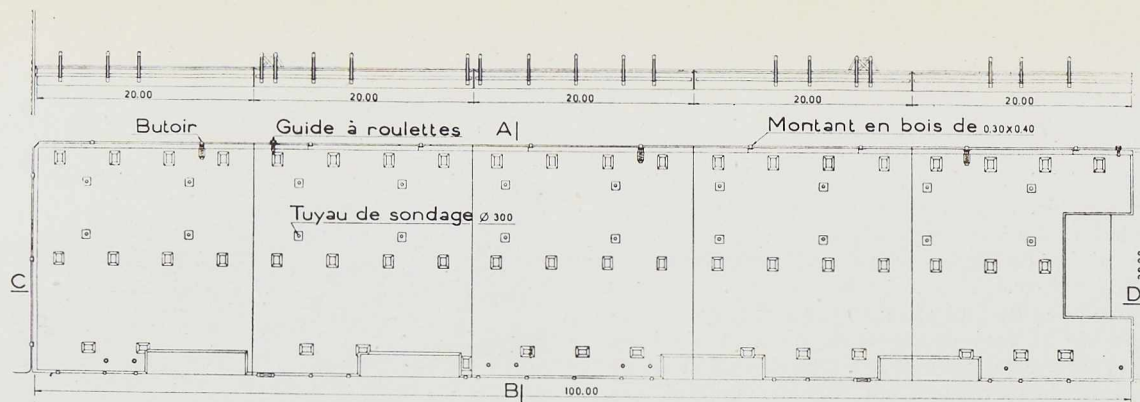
Plan d'ensemble du ponton flottant : il comporte 5 caissons de 400 m² de surface chacun (voir les coupes AB et CD, ci-dessous).
